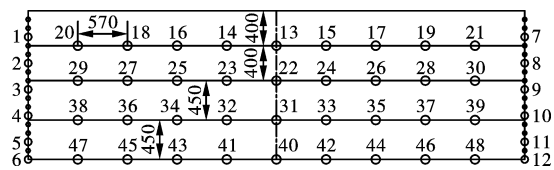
中(下)分层混凝土段一阶炮孔布置图(单位:mm)
